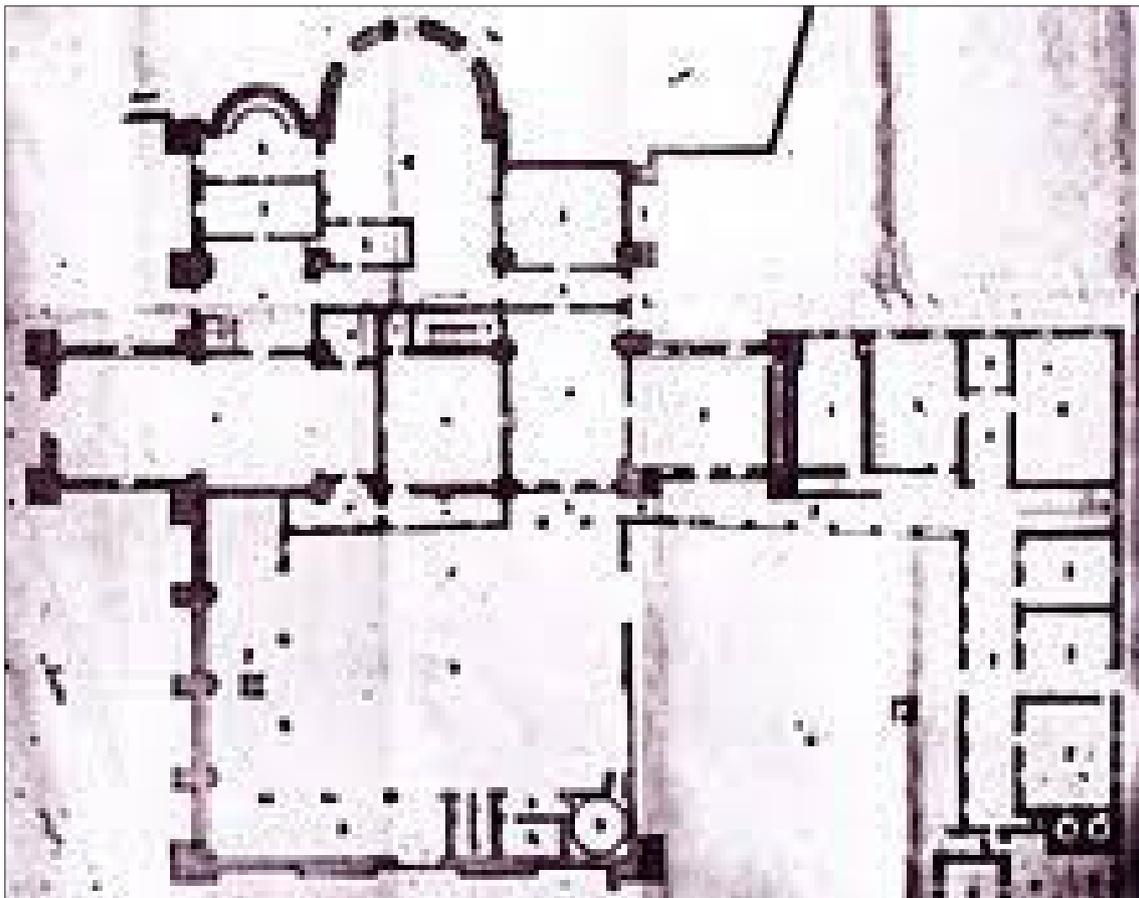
Planimetria di Santa Maria (disegno ing. Pavese, 1812).
